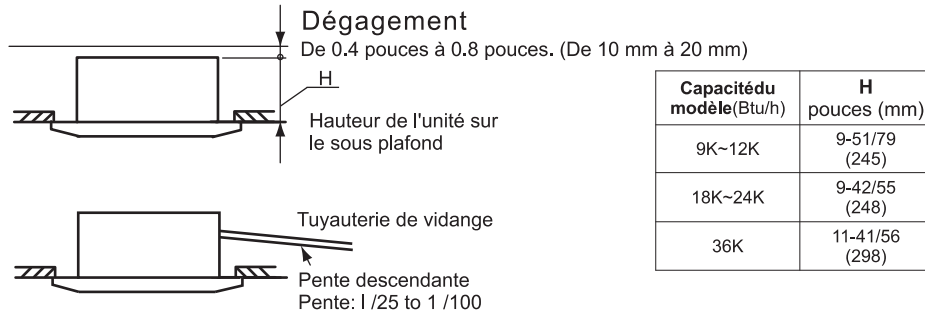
Emplacement de l'installation de l'unité intérieure
